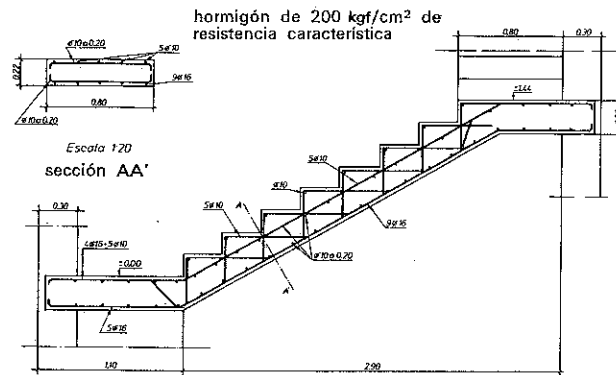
Escalera, seccionada, de hormigón armado.
